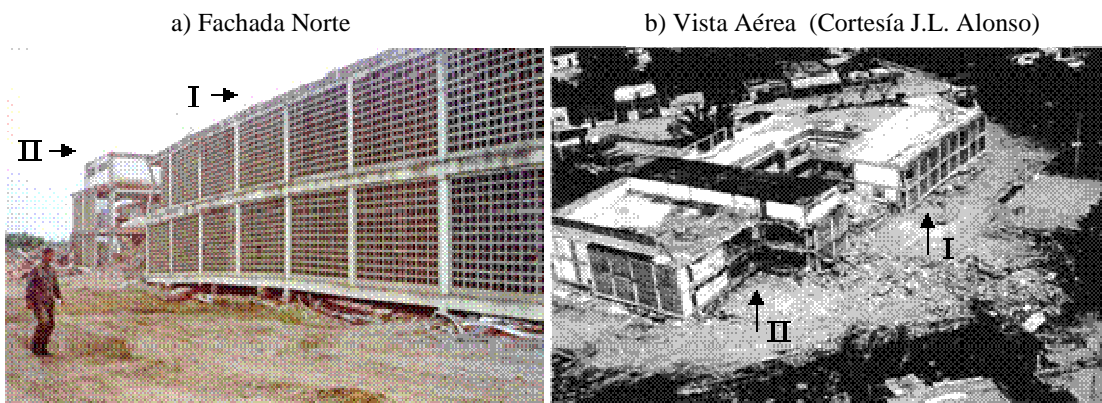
Aplastamiento de la Planta Baja en ambos Edificios I y II
